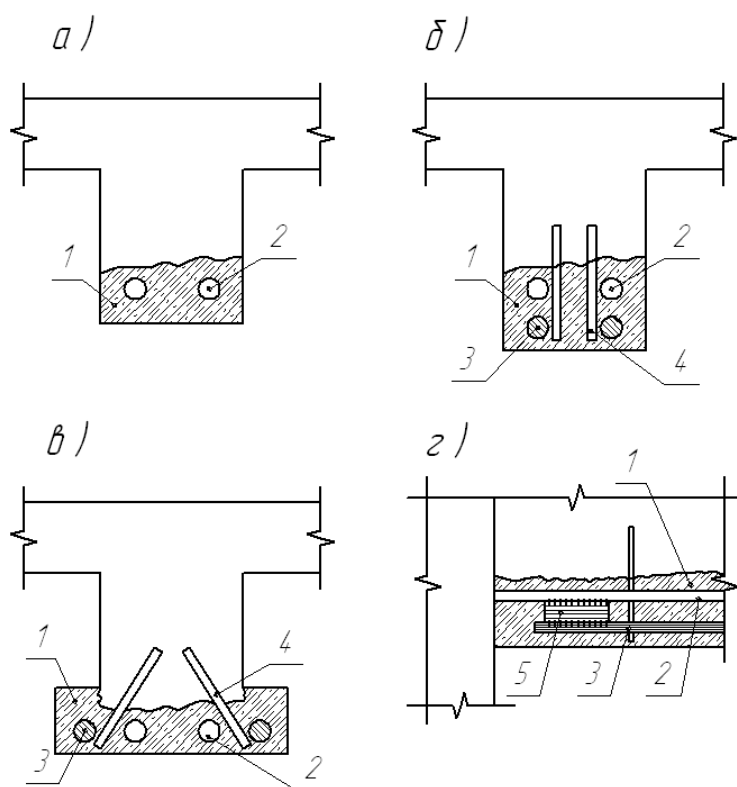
Схемы ремонта балок, несущих настил причала: а) без усиления дополнительной арматурой; б) и в) с усилением; г) соединение дополнительной и имеющейся арматуры у опоры балки.
